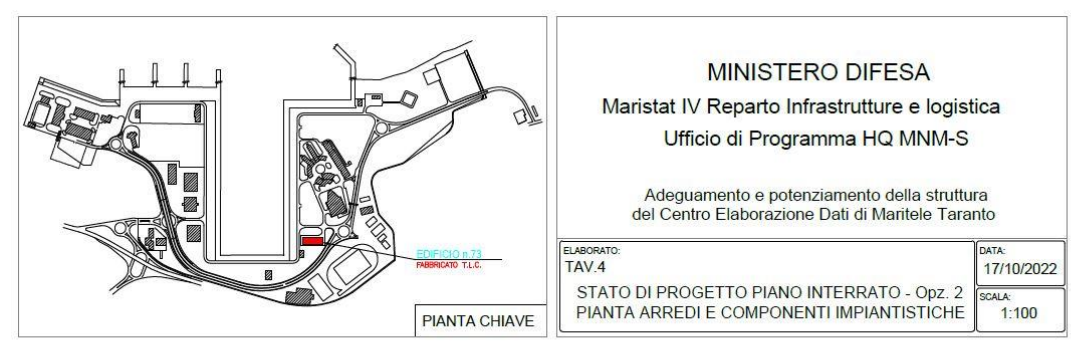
Stato di progetto – Pianta arredi e componenti impiantistiche opz.2
